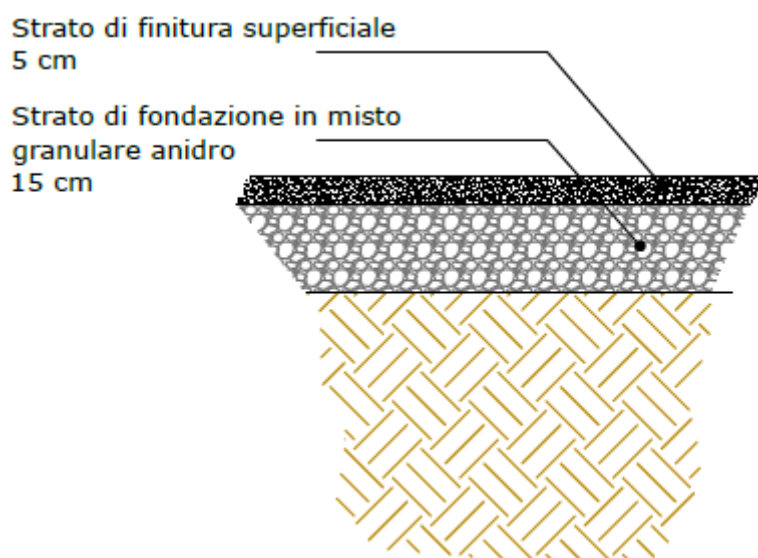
Sezione tipo della pista interna di gestione dell'impianto
